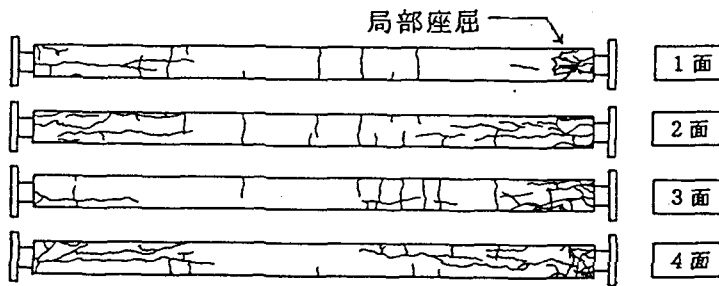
被覆材のひび割れパターン (B-1 試験体、全体座屈直後)
